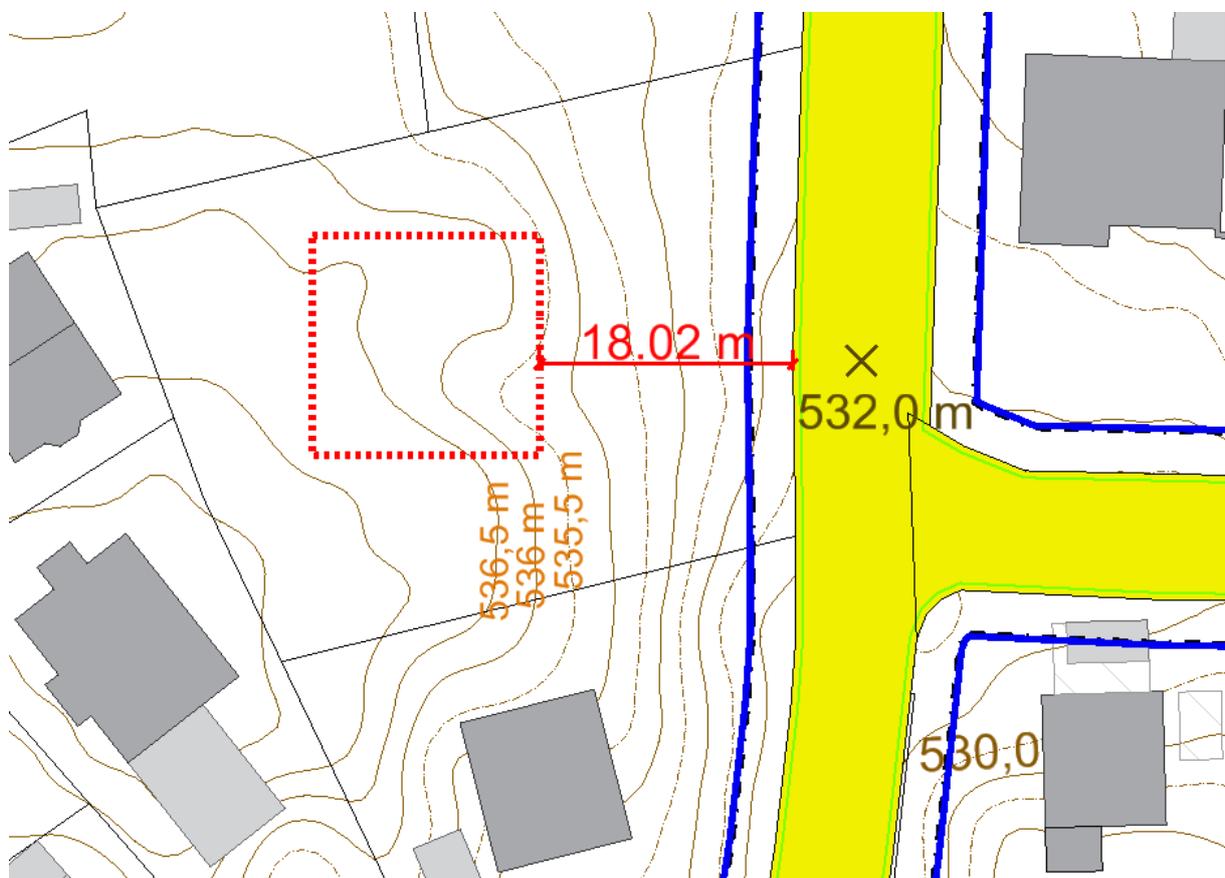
Beispielhafte Darstellung zur Ermittlung der Bezugsgeländehöhe eines Gebäudes (Baukörpers rot gestrichelt) anhand der angeschnittenen Höhenlinien (relevante Höhenlinien beschriftet)
